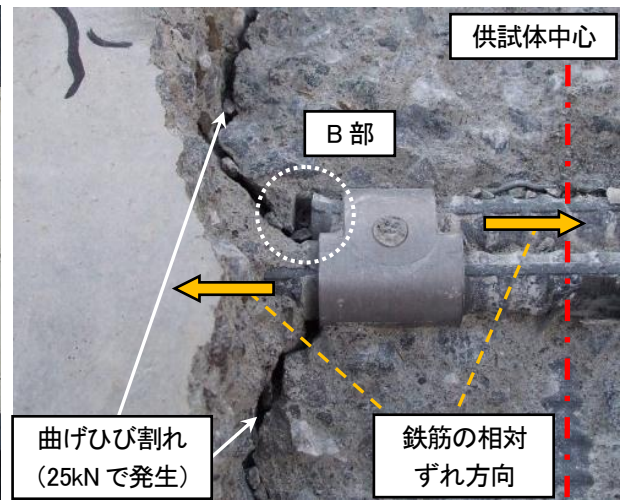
実験終了後の C3 供試体内部の鉄筋継手の状況
